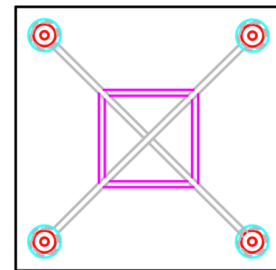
Section carrée avec raidisseurs diagonaux et tubes soudés
